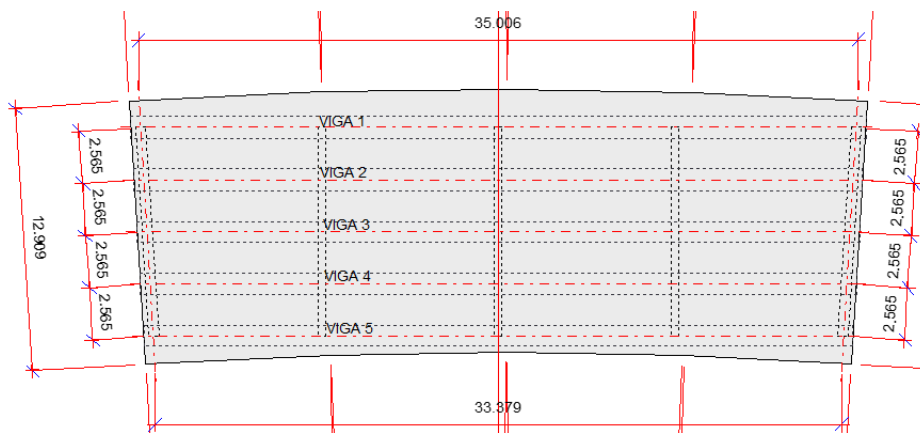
Planta de estructura. Fuente: IDOM-DEHC.
